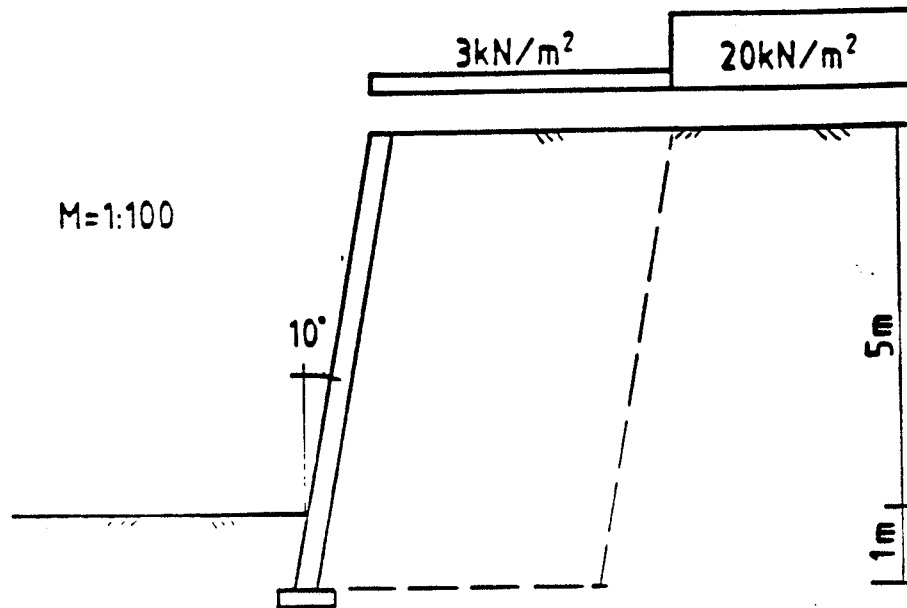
STØTTEKONSTRUKSJON I ARMERT JORD
